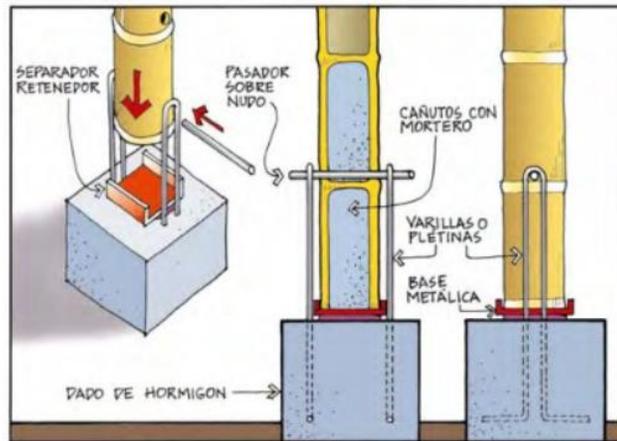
Unión cemento-columna. Fuente: AIS 2010
